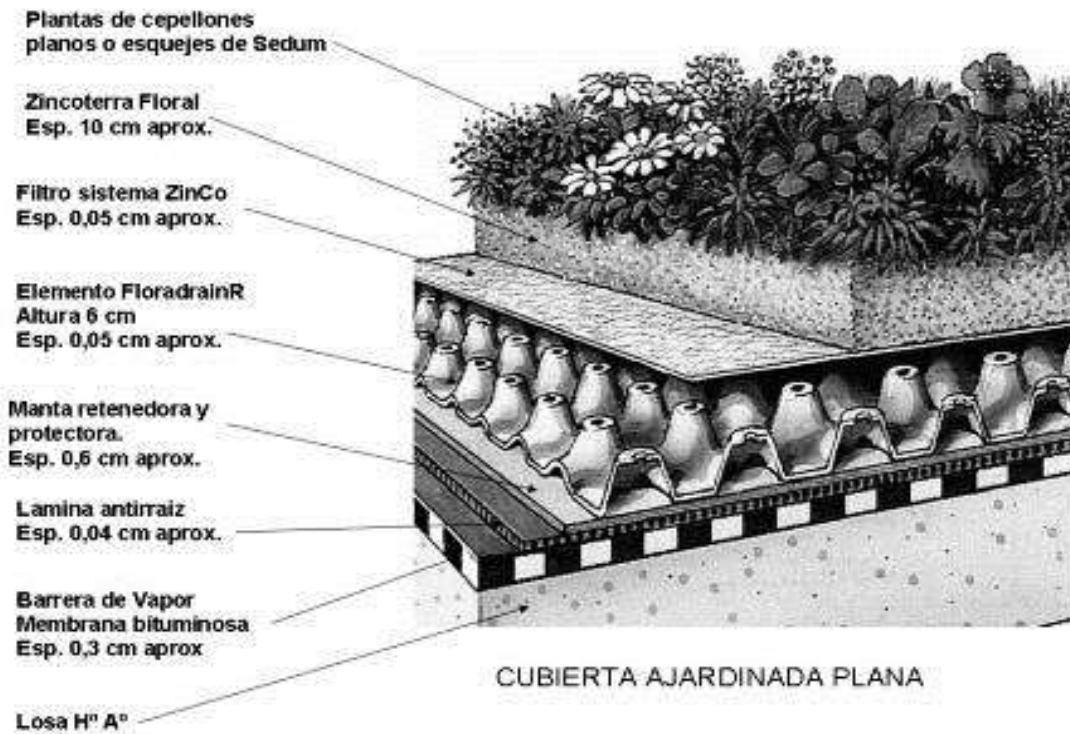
Sistema Floradrain Fd 25 instalado por la empresa Zinco. Se observa variedad de plantas tipo sedum. Fuente: Ficha técnica cubiertas verdes. Arqgeo Green Roof Chile Ltda. Octubre 2013.
